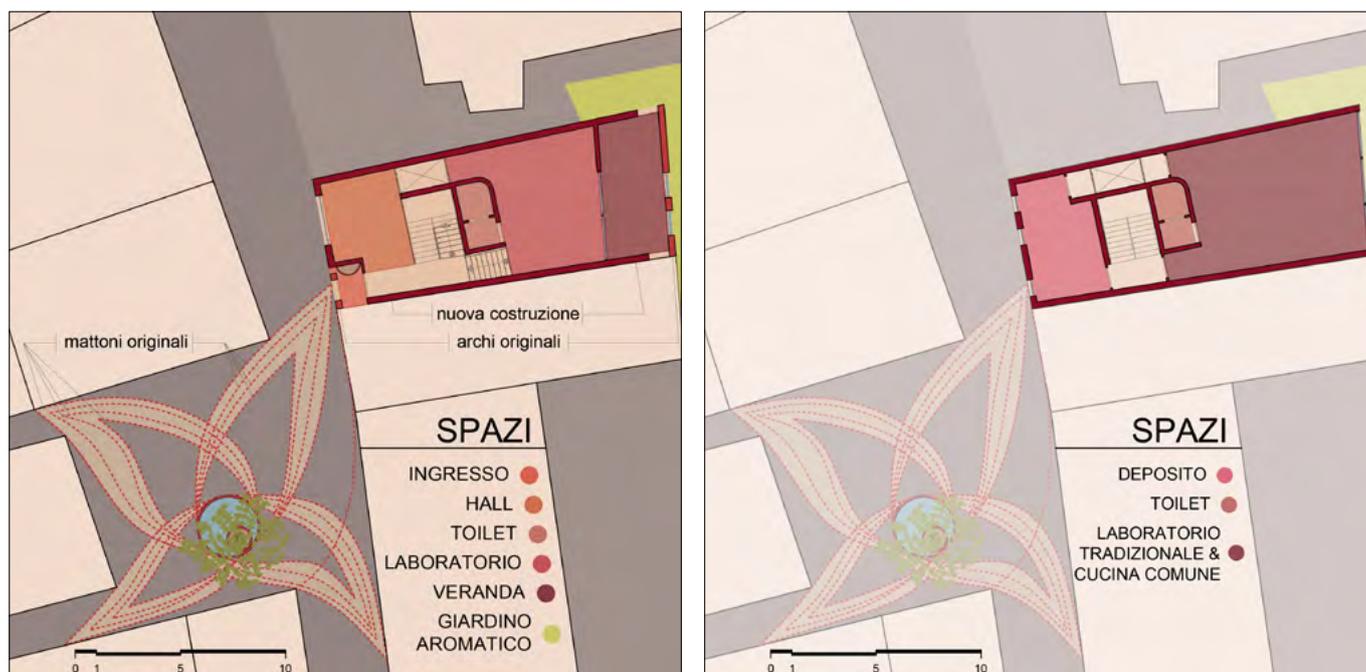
e 6. Masterplan della common house, piano terra e piano primo
